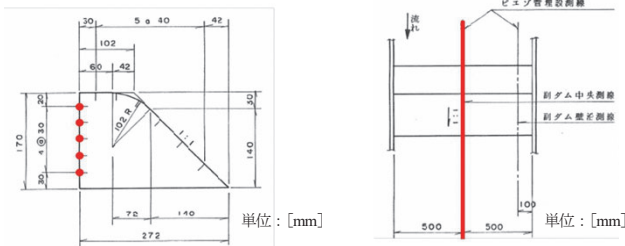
副ダム圧力計測位置(左:断面図、右:平面図)
